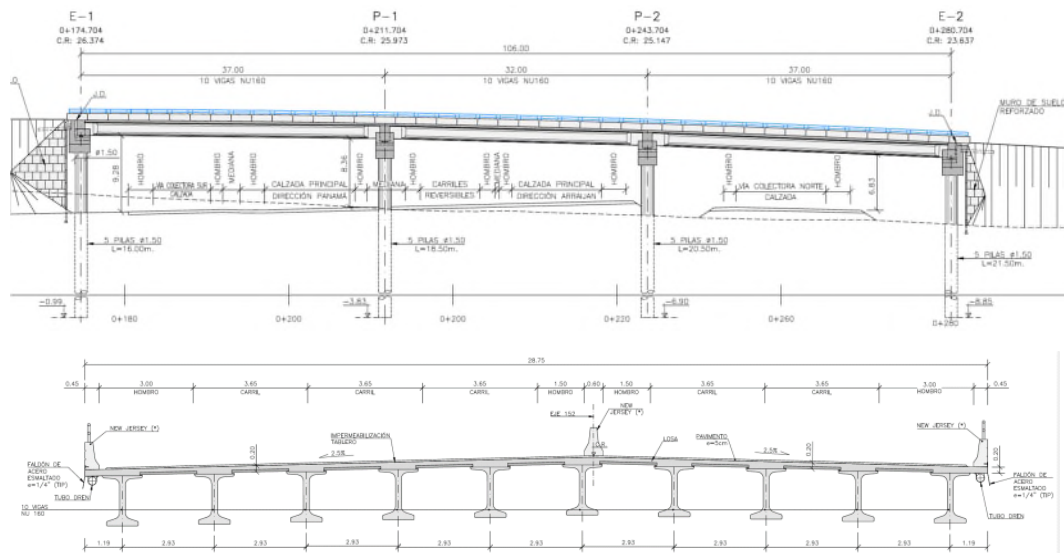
Alzado y sección del tablero de la estructura E-2. Paso superior con tablero de gran ancho
